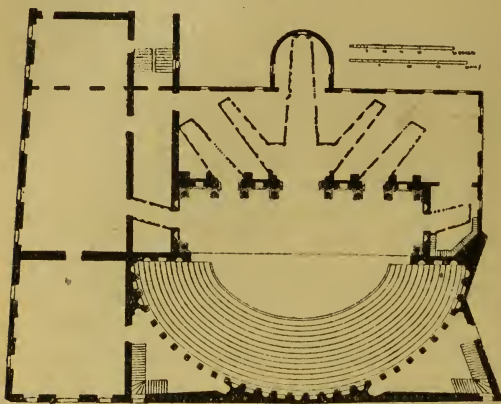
Grundriss des Teatro Olimpico in Venedig.
